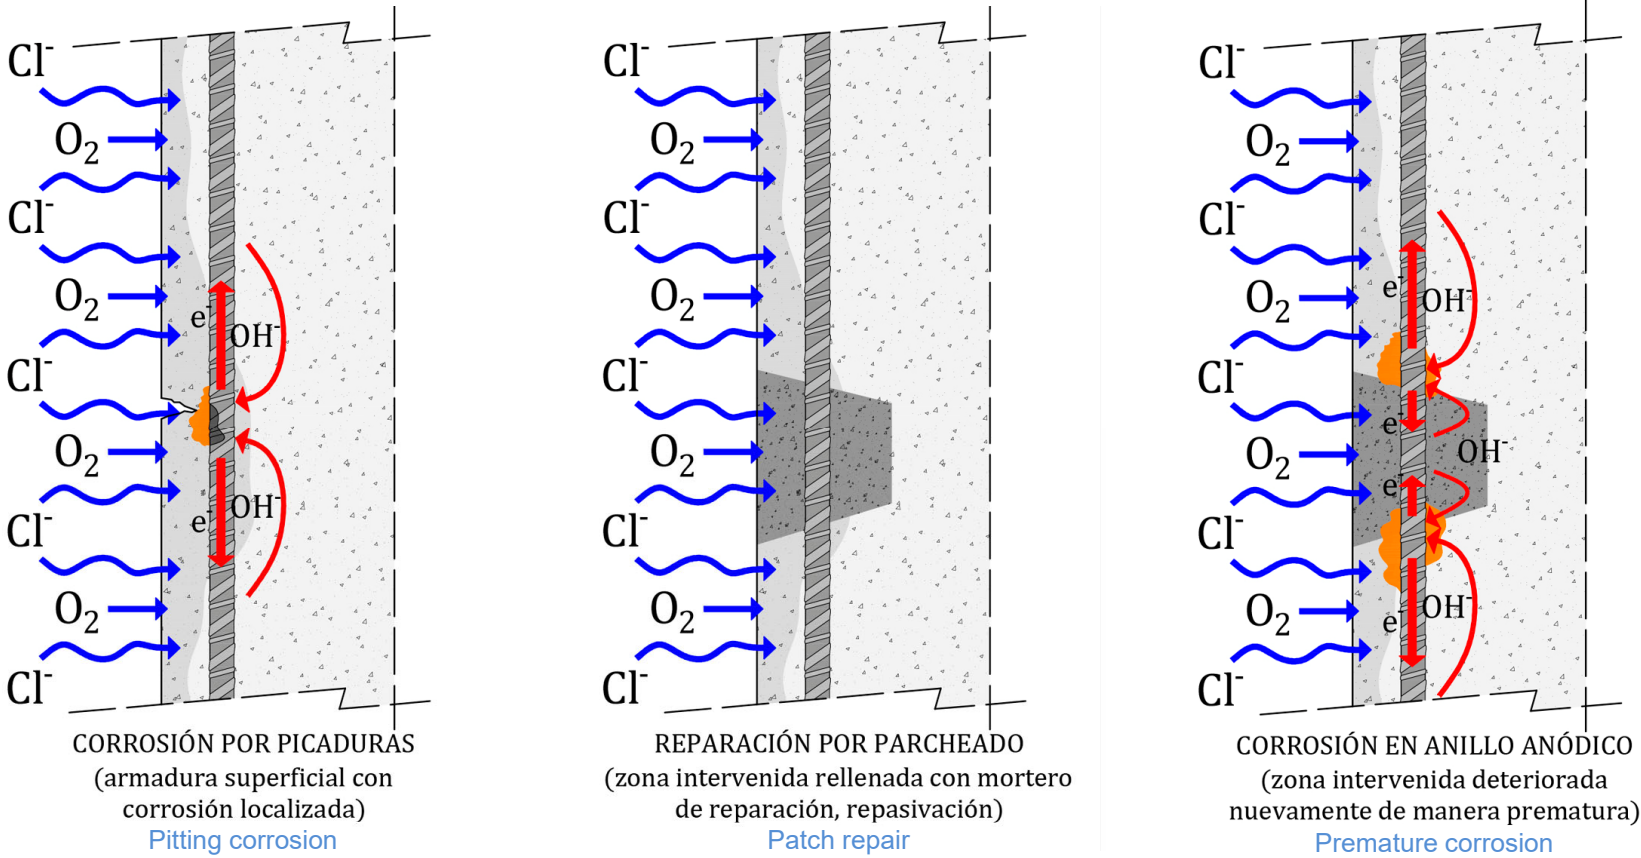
Proceso de reparación mediante parcheado de una estructura de hormigón armado
